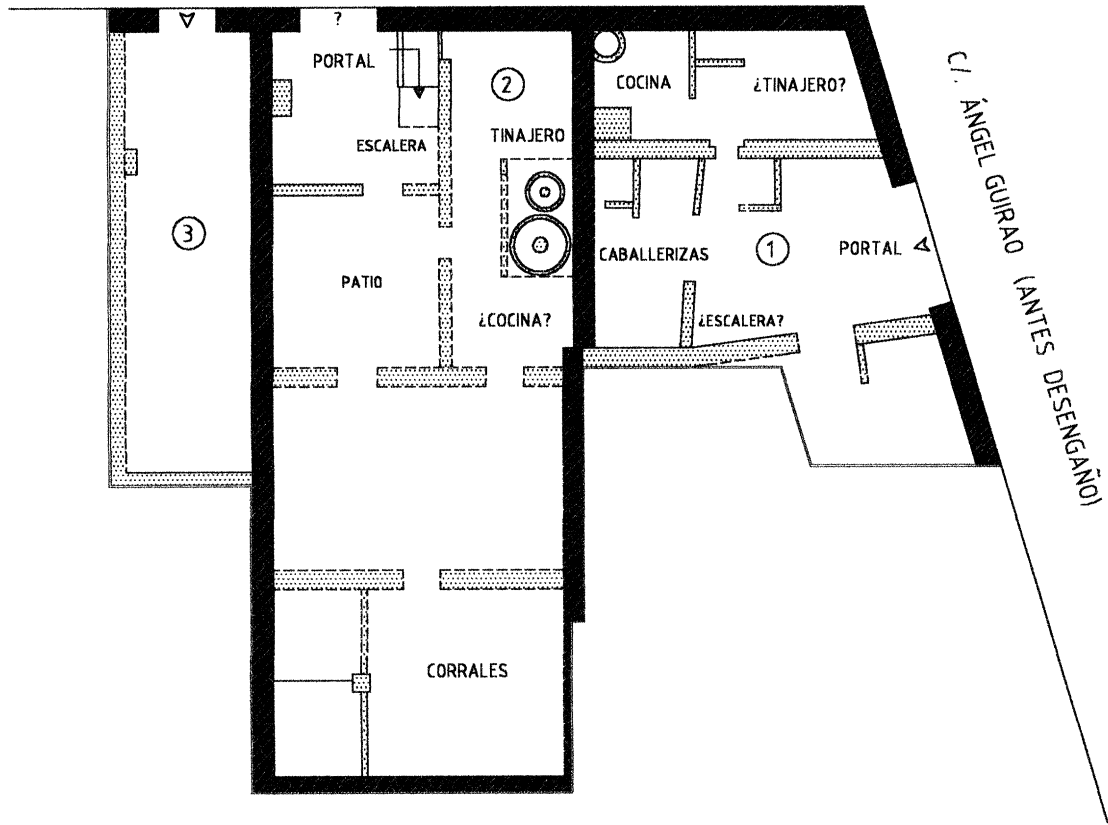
Planta de las viviendas barrocas en su fase fundacional (siglo XVII).
